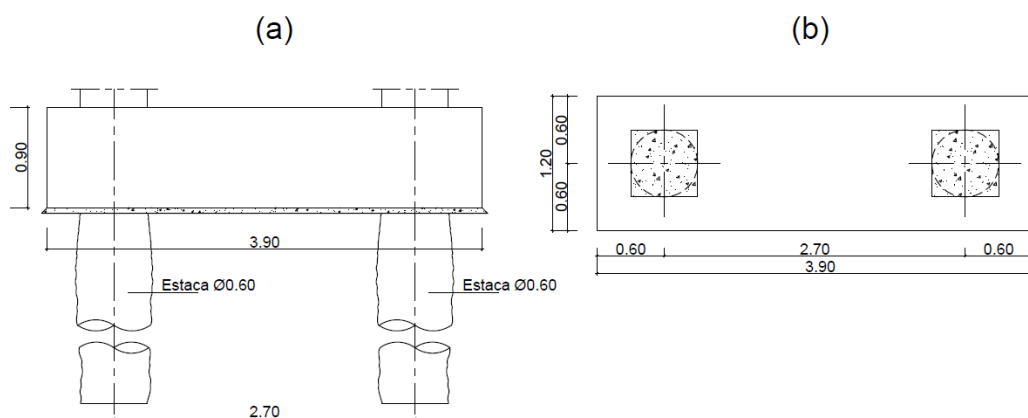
Fundação indirecta do pilar P1: (a) Alçado transversal; (b) Vista em planta [2]
